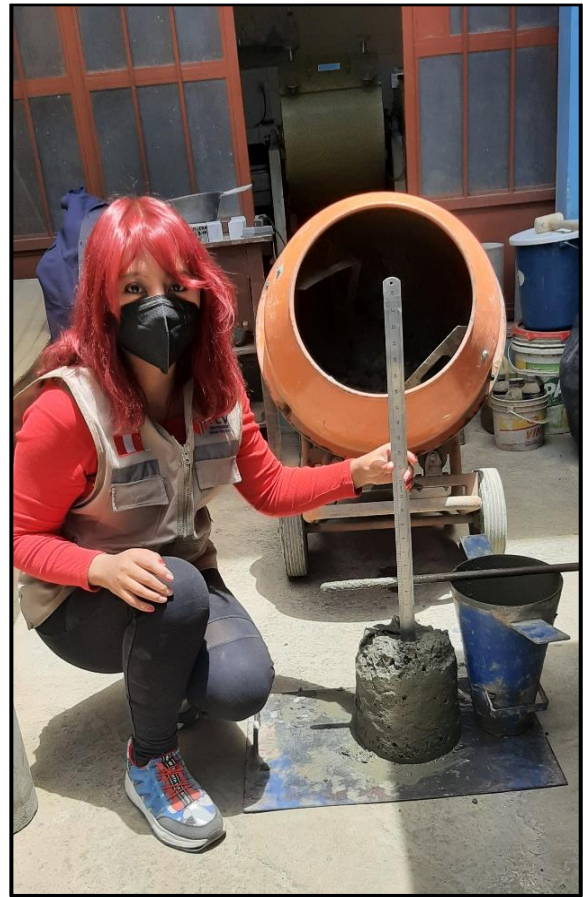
Ensayo de Asentamiento (Slump) del concreto patrón.
